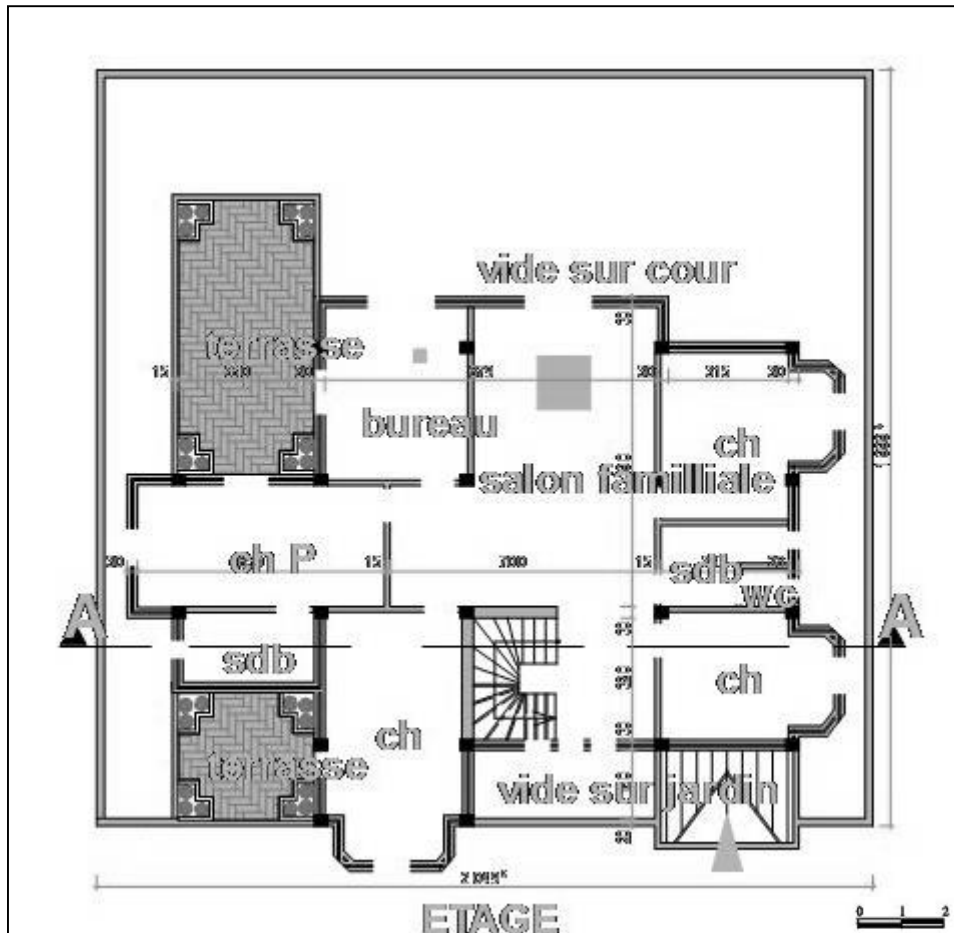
, échantillon 05, plan ETAGE d'une habitation individuelle prise comme plan type d'une maison a standing, lotissement OMAR BEN KHATTAB
